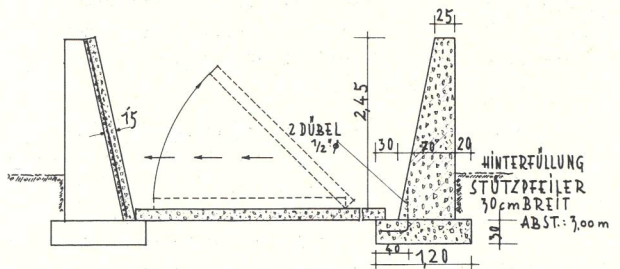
(unten): Grabensilo aus Beton-Hohlblock-Steinen.
